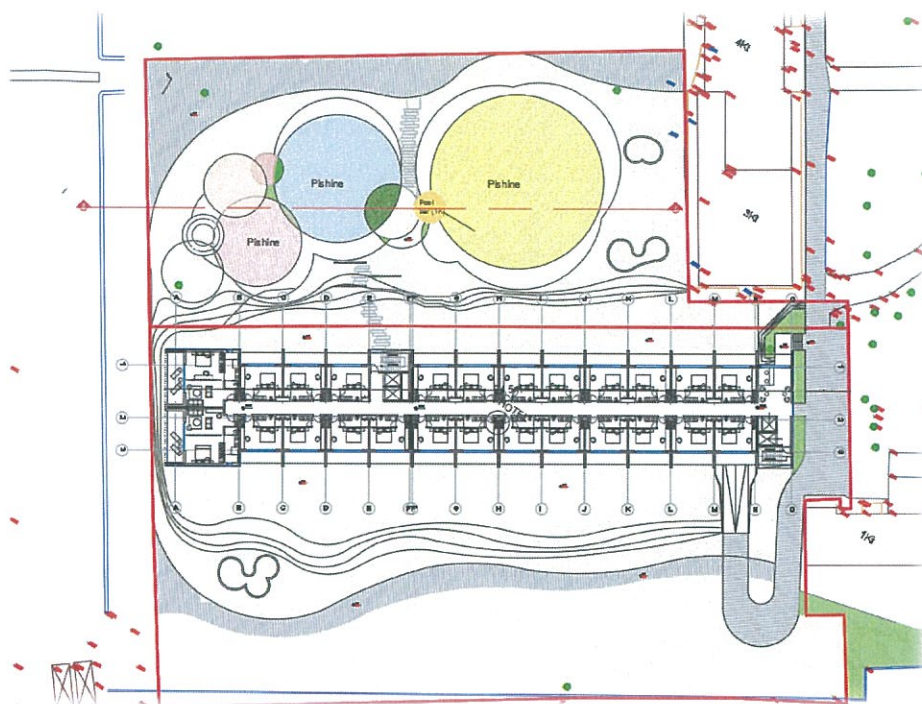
Plani i hapësirave të jashtme të objektit të propozuar
